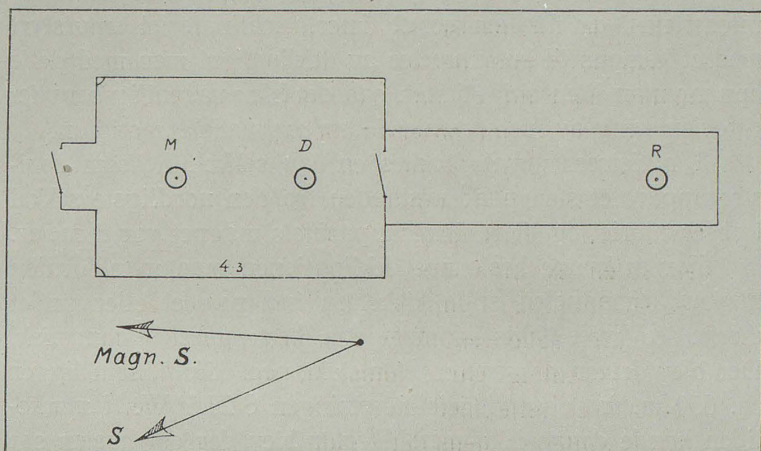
Grundriss av det magnetiske observatorium.
